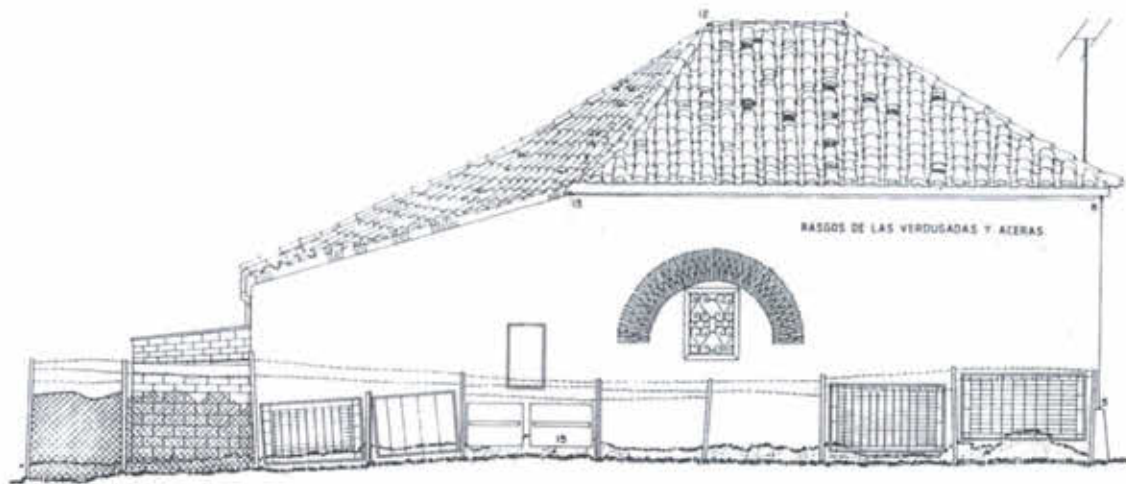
Alzado Norte de la ermita de San Roque (Fuente: CAMPUZANO MARIN G. y M. ANTONIO GARCES DESMAISON: Traslado y restauración de la ermita de San Roque. Madrid, Distrito de Fuencarral. Propiedad Junta de Compensación 8.5.1. Industrial Isla Jamaica. Madrid, 1994).
